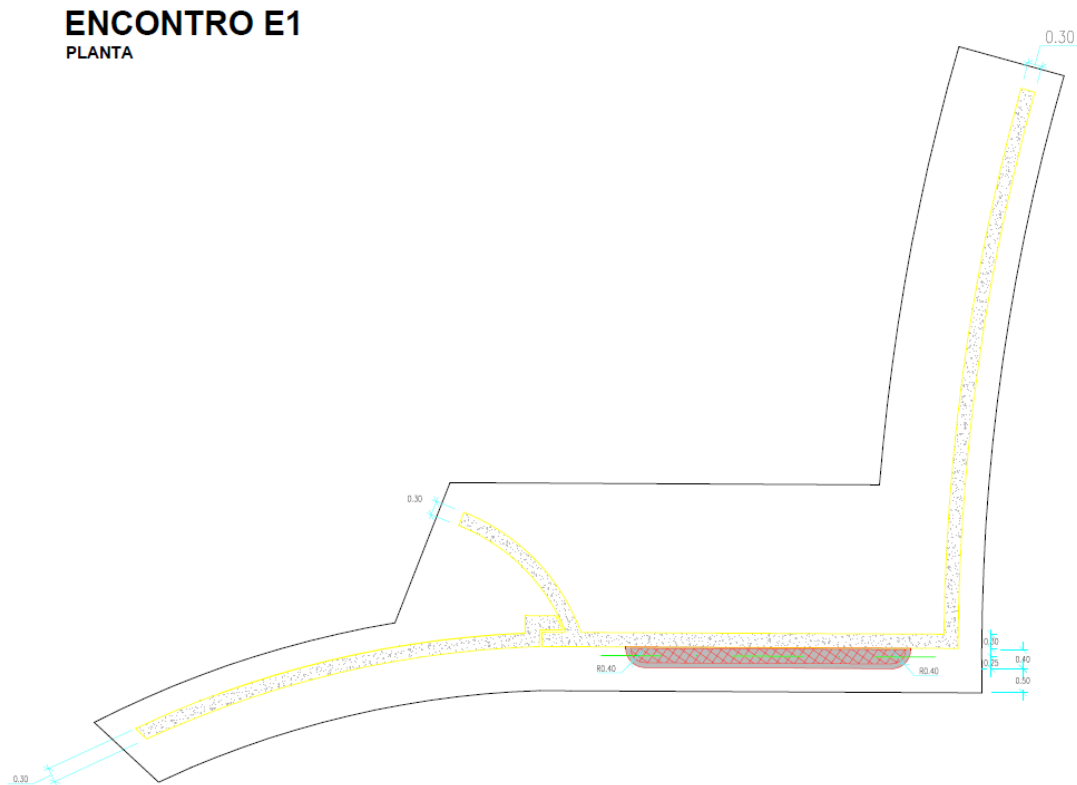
Planta do encontro E1. 1ª localização aconselhada.
